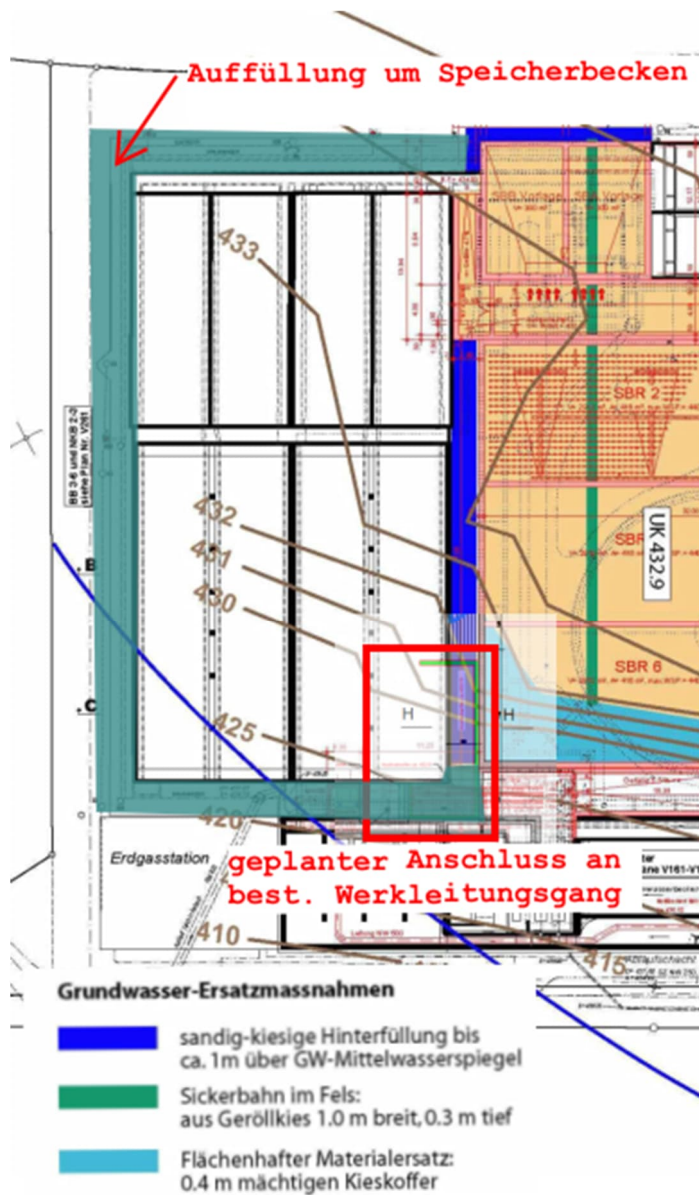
Ausschnitt Grundwasserersatzmassnahmen SBR Ausbau mit Auffüllung Speicherbecken
